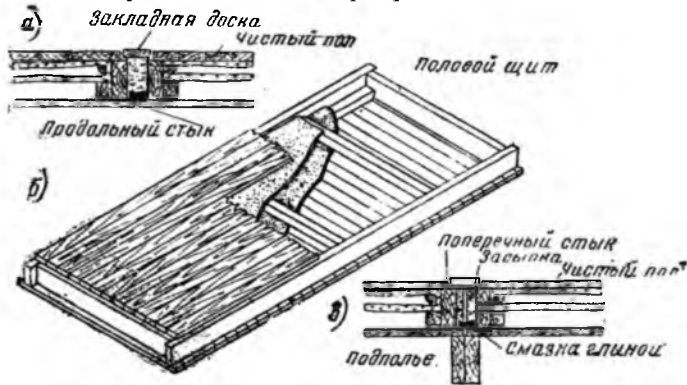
Конструкция нижних перекрытий сборного щитового строительства
